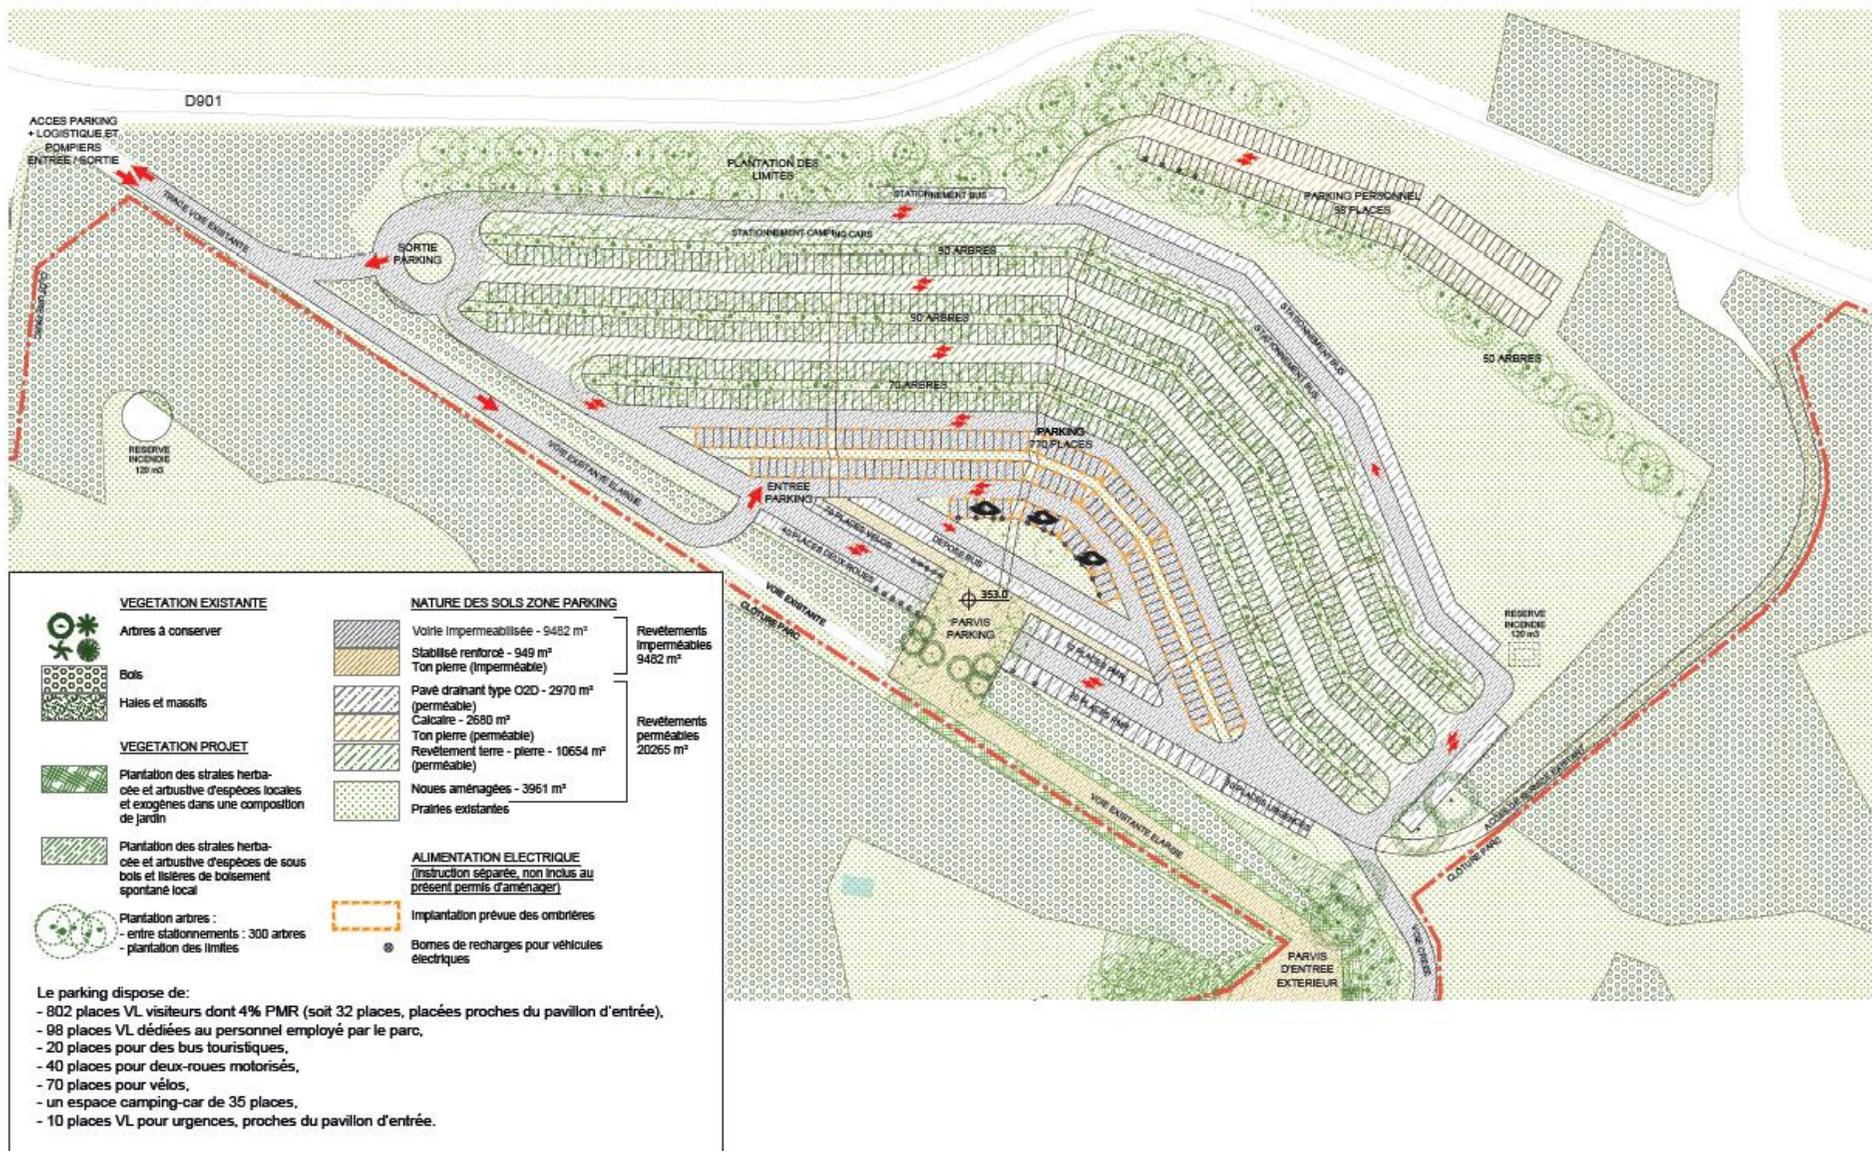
Plan du parking du projet (Source : Notice explicative – COCO Architecture, décembre 2022)
